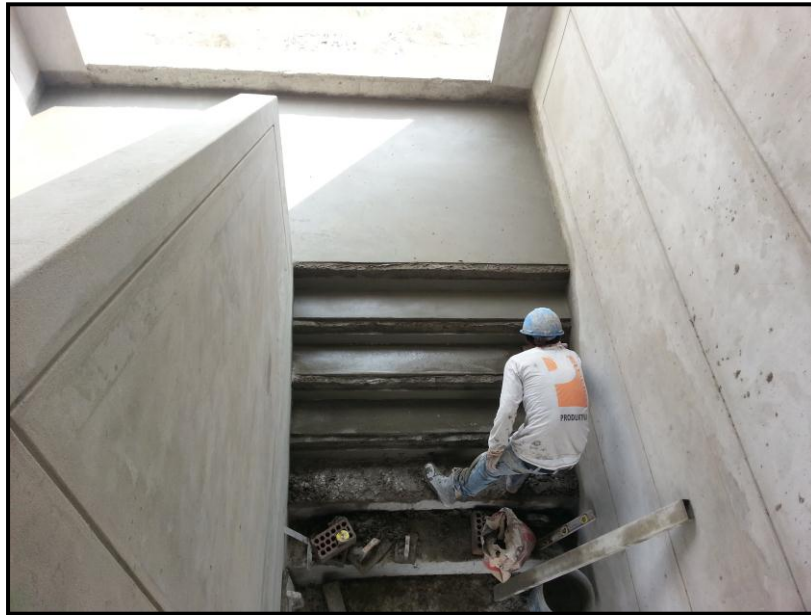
FOTO PROYECTO L. Preparación de gradas de escalera con cemento pulido.
